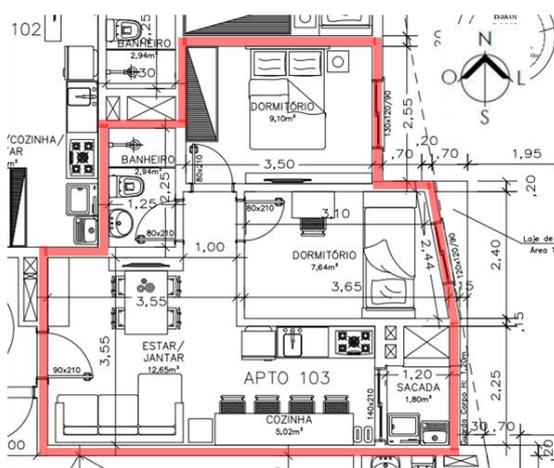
Na Figura 25, planta baixa térreo do apartamento cento e três (103) tem área privativa de 50,86 m<sup>2</sup>. E planta baixa cobertura, representando também os apartamentos tipos (203/303/403) com área privativa de 50,86 m<sup>2</sup> (Figura 26). Tanto o térreo quanto a cobertura, representam a mesma tipologia e área com ambiente integrado cozinha e sala, 2 dormitórios, 1 banheiro com janela para um *shaft* de ventilação e uma sacada com churrasqueira. Apartamentos finais 03 possuem a orientação solar para leste na varanda/sacada e nos 2 dormitórios.
